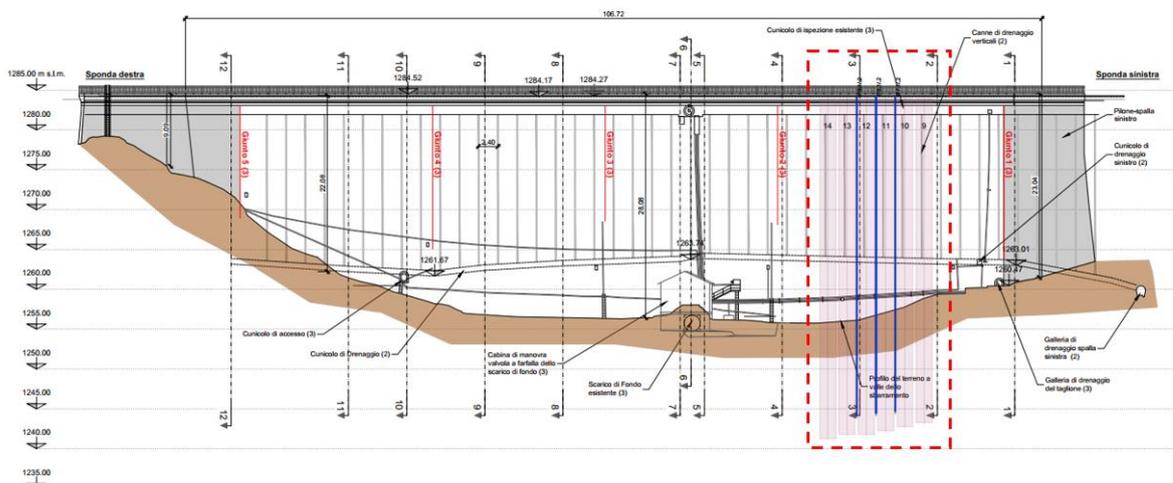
Profilo (visto da valle) con ubicazione dei campi prova propedeutici alla realizzazione delle iniezioni di consolidamento e del nuovo sistema di drenaggio.
